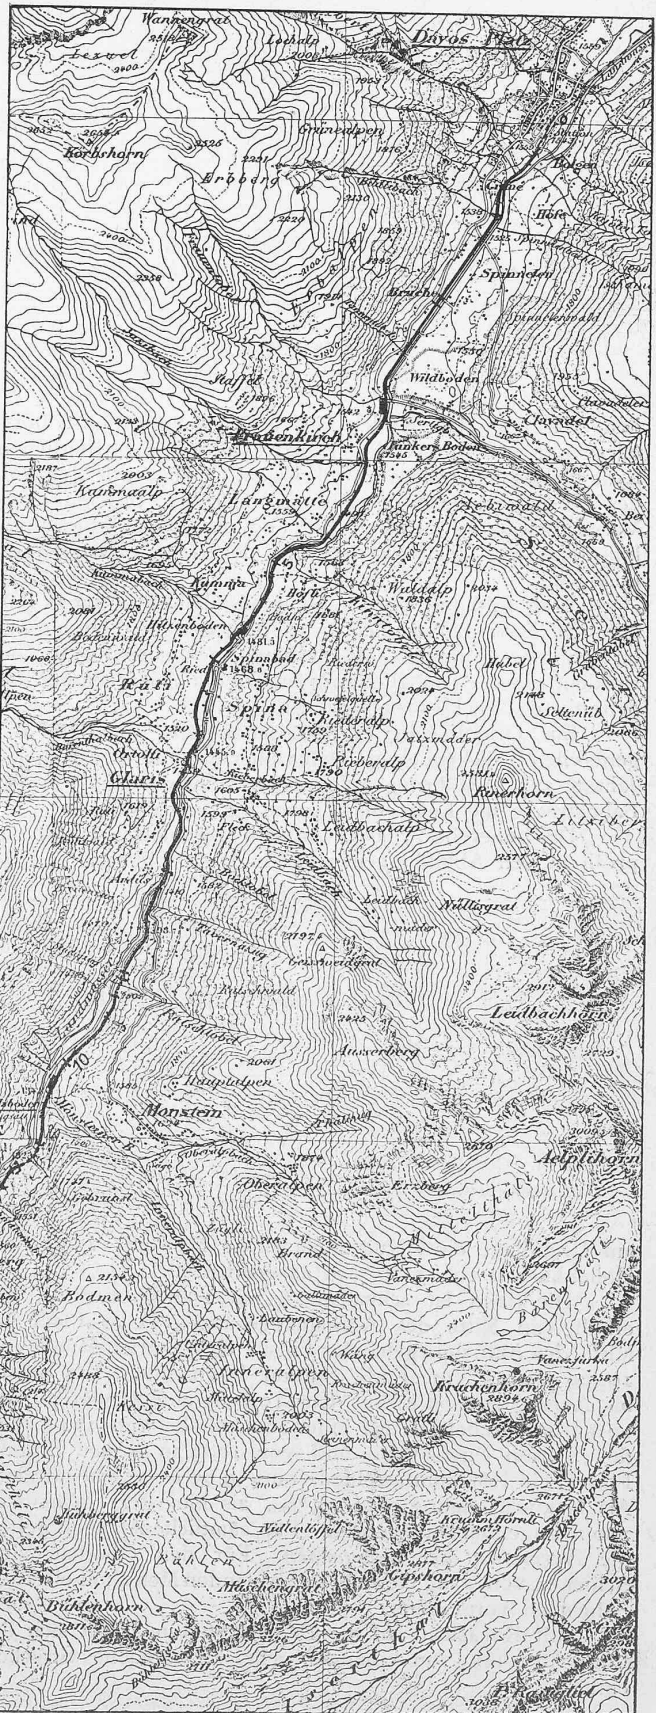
Lageplan. — Masstab 1 : 60 000.
